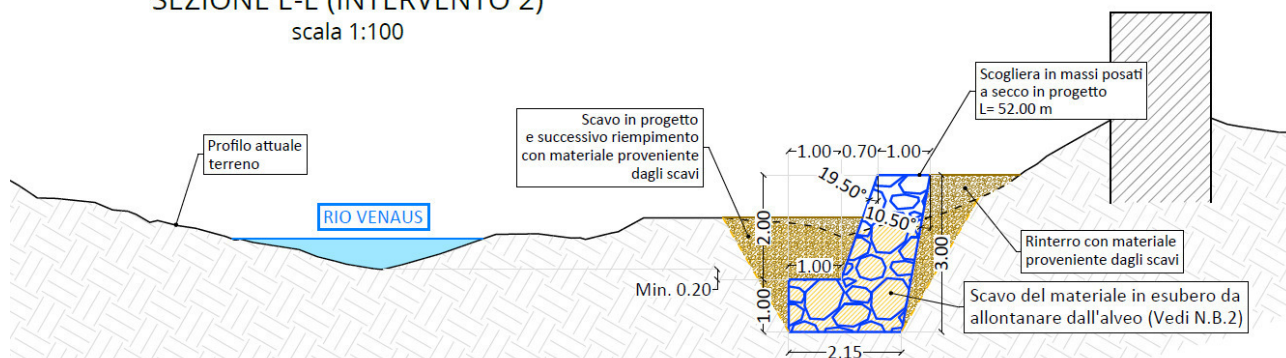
Estratto della tavola 06 - Sezioni di progetto
